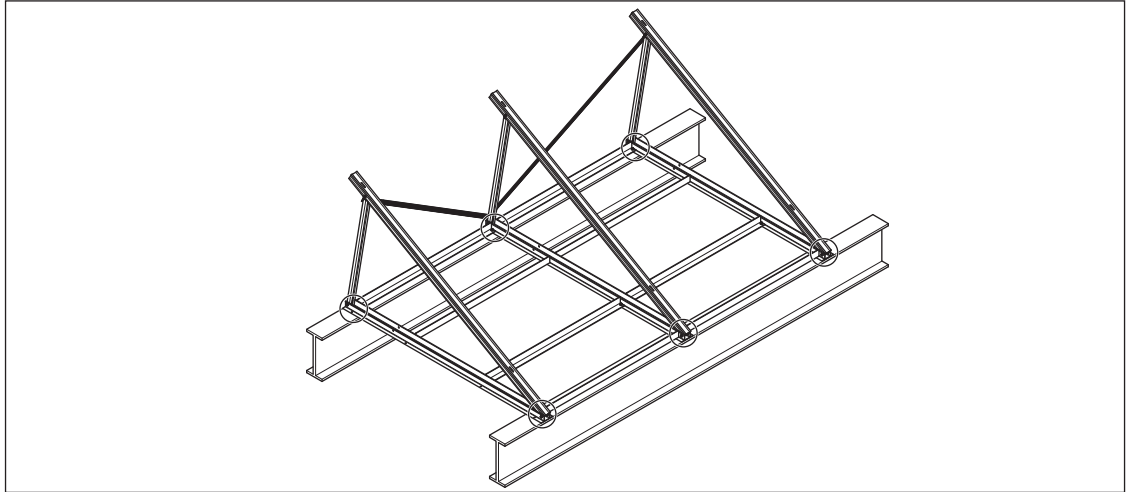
Aseguramiento de la construcción independiente en tejado plano mediante subestructura
